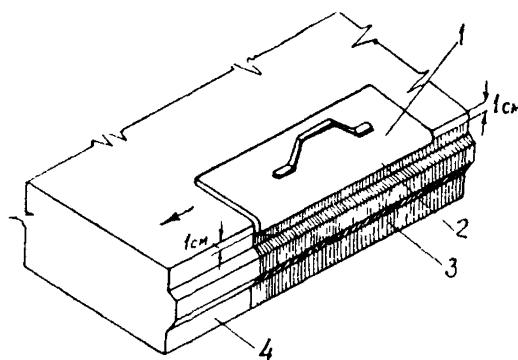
Шаблон для предотвращения попадания разжиженного битума или мастики на кромку бетонного покрытия:
